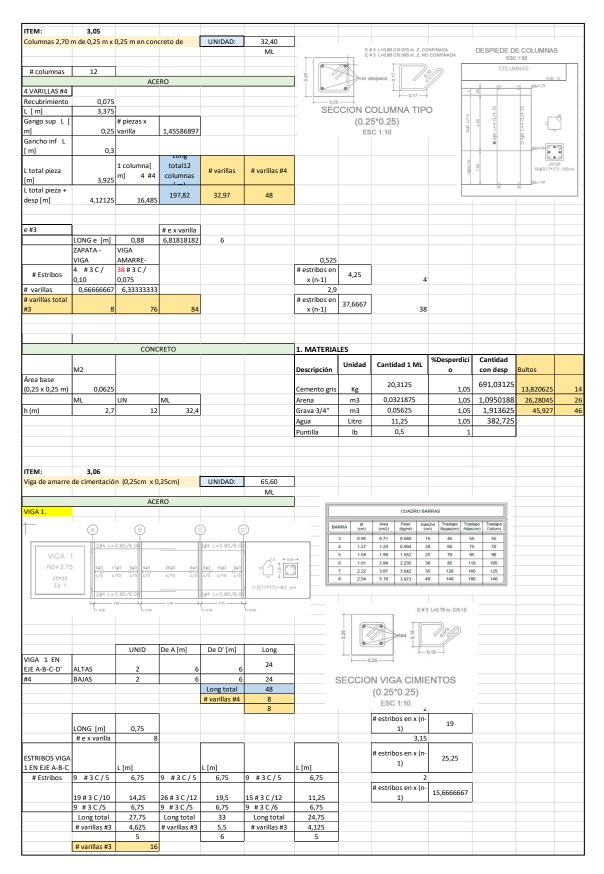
Memoria de cálculo – Cimentación y Estructuras en concreto – Parte 3.
